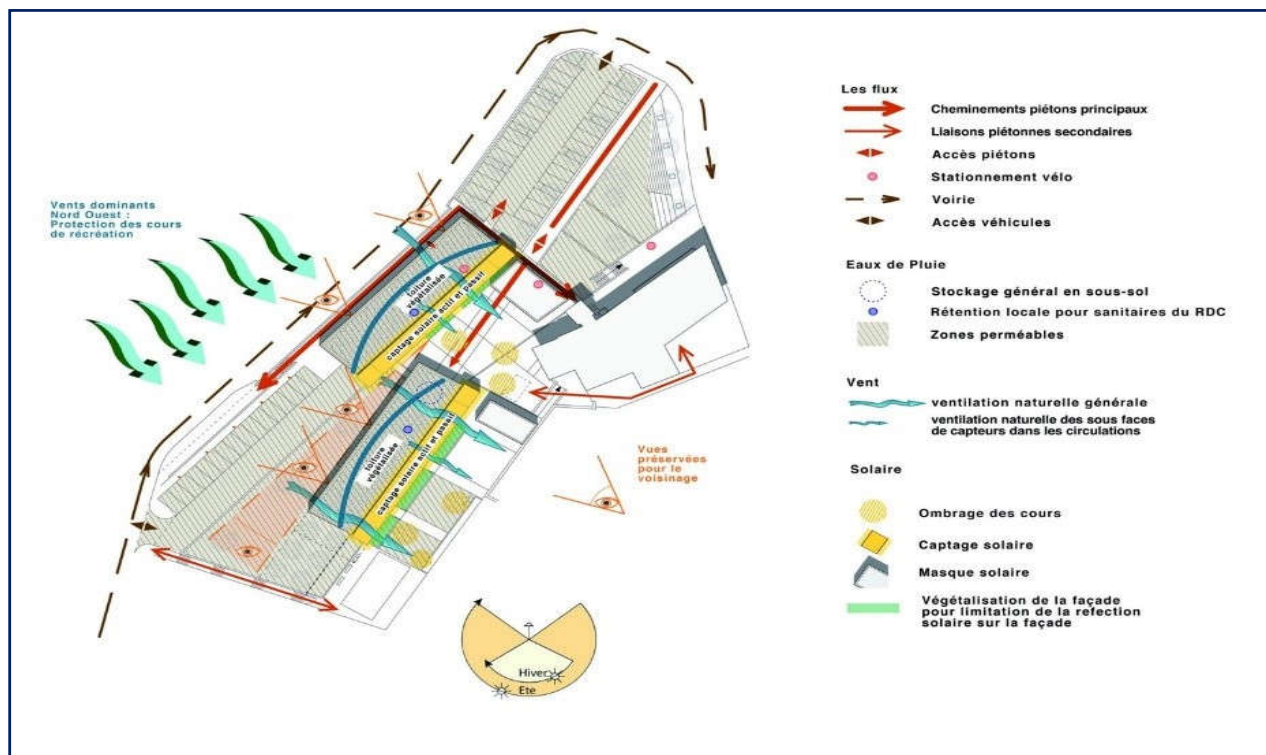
plan de masse. Source : Reportage_chantier_montrouzier_VAD.pdf
